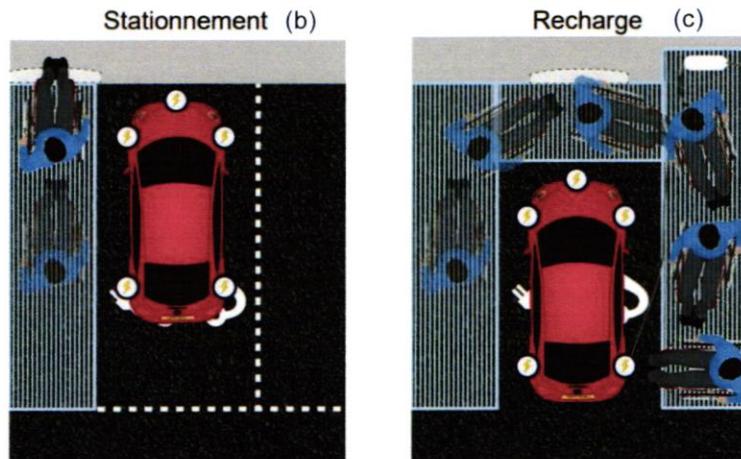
Surlargement nécessaire pour permettre l'accessibilité PMR d'un stationnement (b) et d'un stationnement équipé d'une borne IRVE (c) – Source : Cerema
